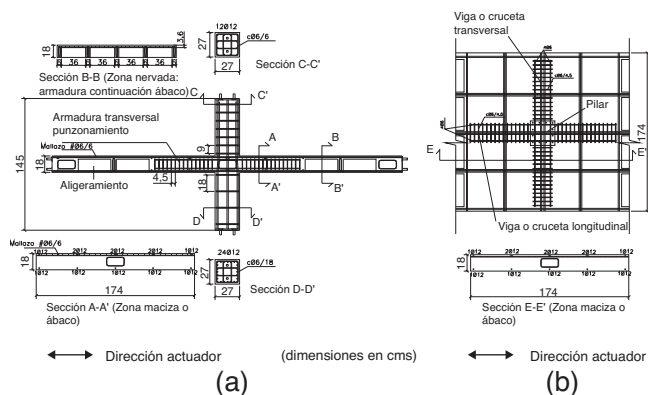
Geometría del espécimen conexión interior: a) alzado; b) planta.
